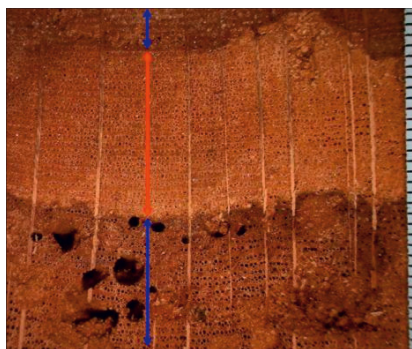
Ausgebreiteter Hausporling (↑) und Kellerschwamm (↓), Detail: eng verwobene Befälle in einem Bauteilausschnitt; Maßstab mit Millimetern.
